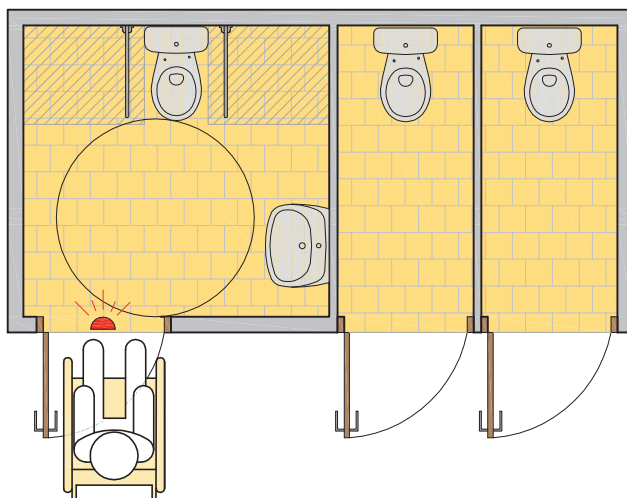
Vista en planta de un aseo accesible con inodoro y lavabo.
